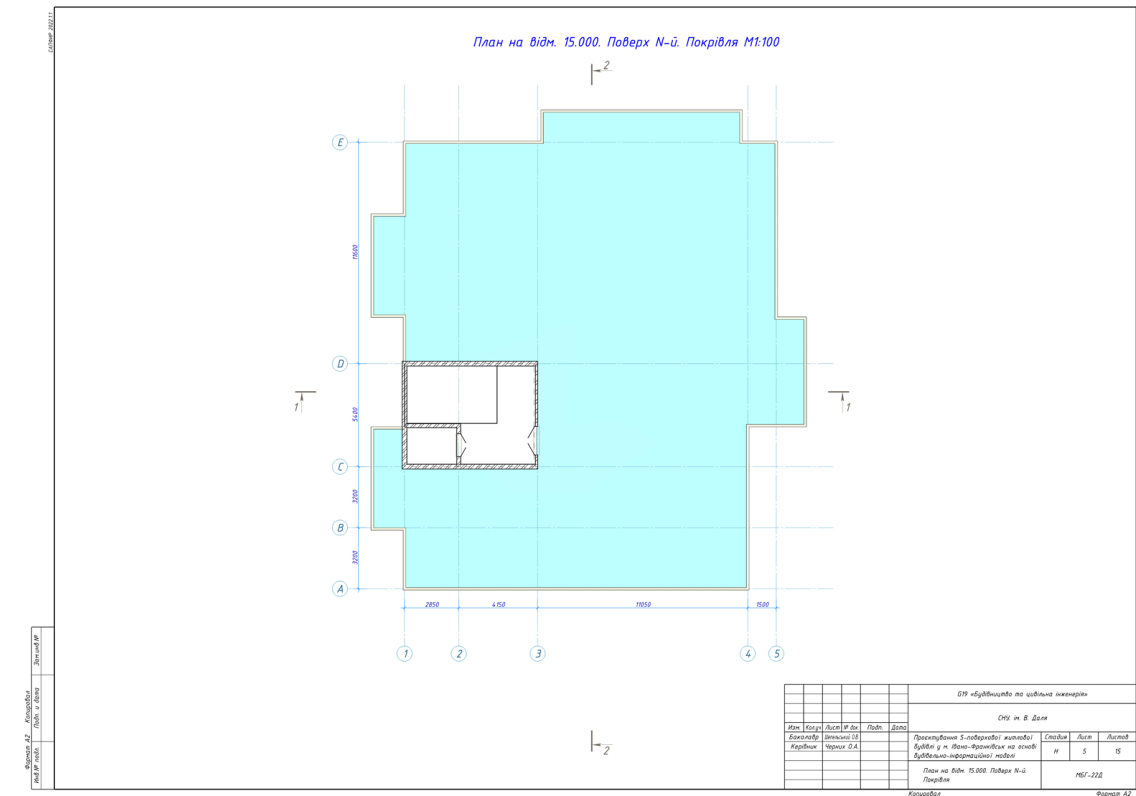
План на відм. 15.000. Поверх N-й. Покрівля.
